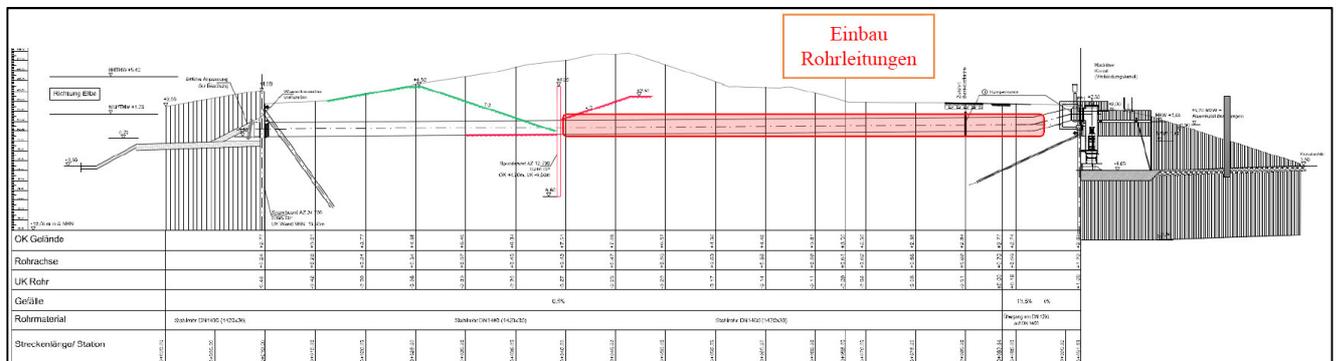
Bauabschnitt 2 – Bauphase 2.2
